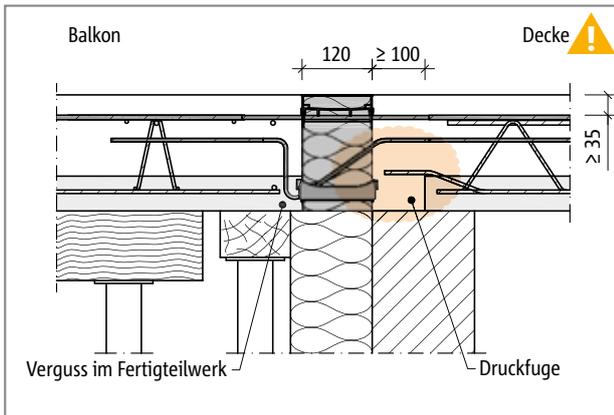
Schöck Isokorb® Typ KFXT: Druckfuge deckenseitig in Verbindung mit Elementplatten; direkte Lagerung
